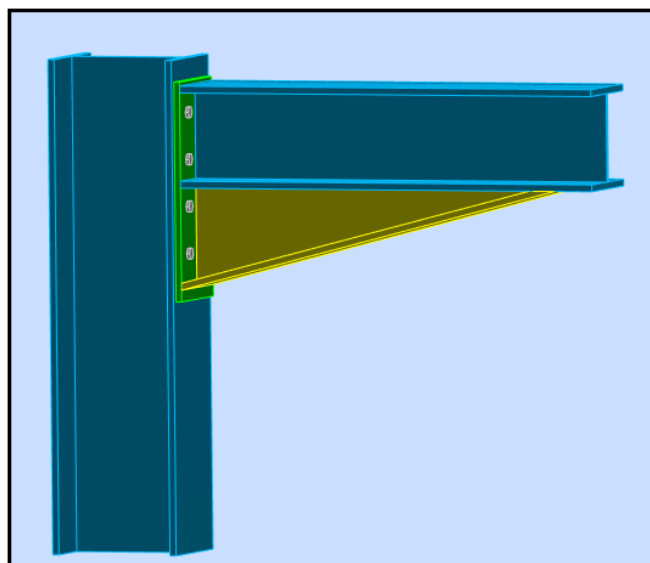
Vue 3D de l'assemblage poteau-console de la poutre de roulement.
